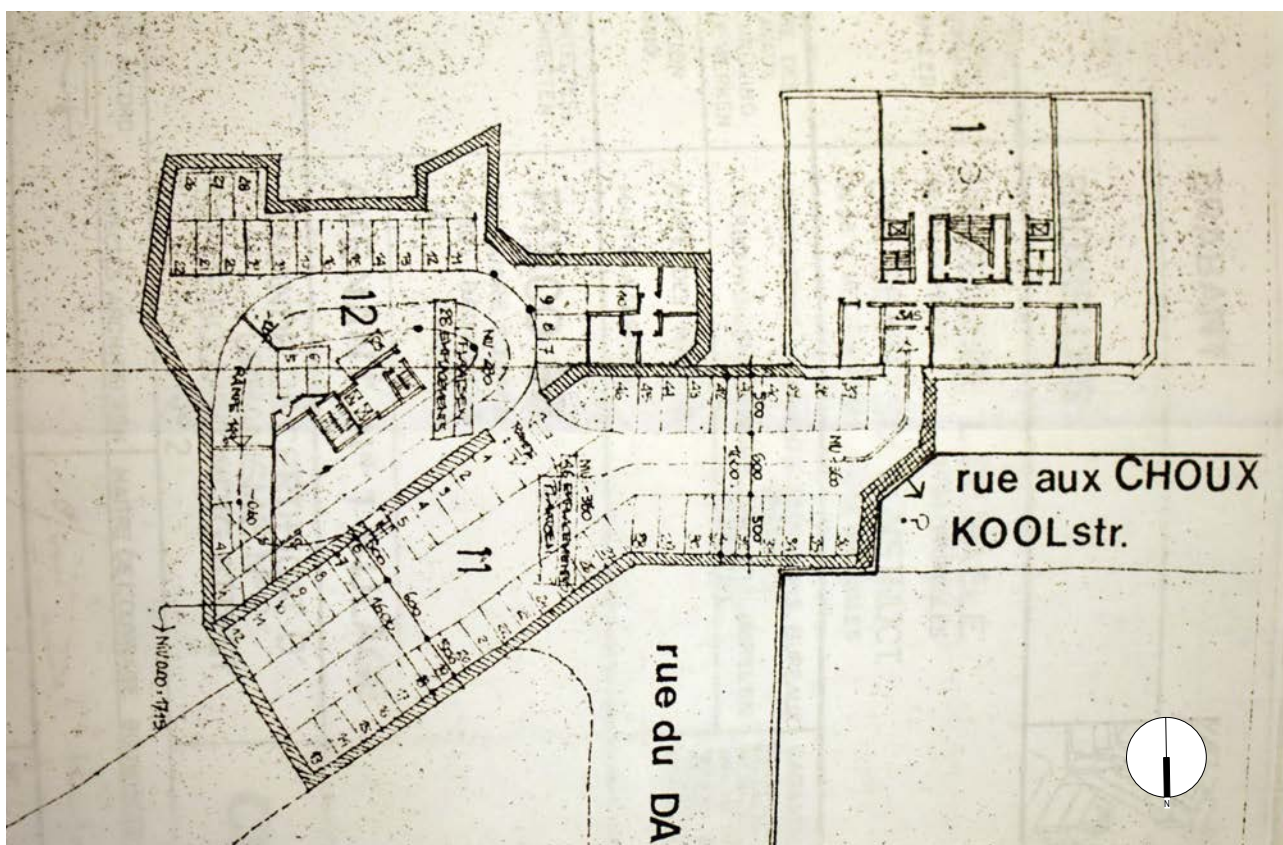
uit het bouwaanvraagdossier van 1989 (SAB TP96062)
